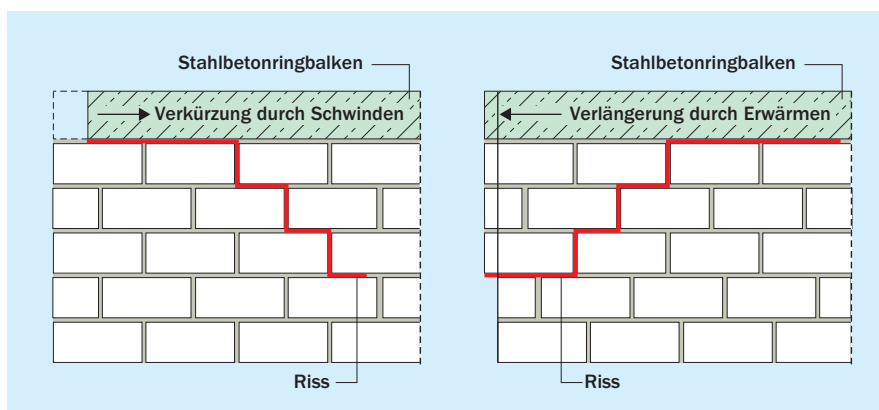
Verformungsfall H4: Verformung von einem ungedämmten Stahlbetonringbalken
